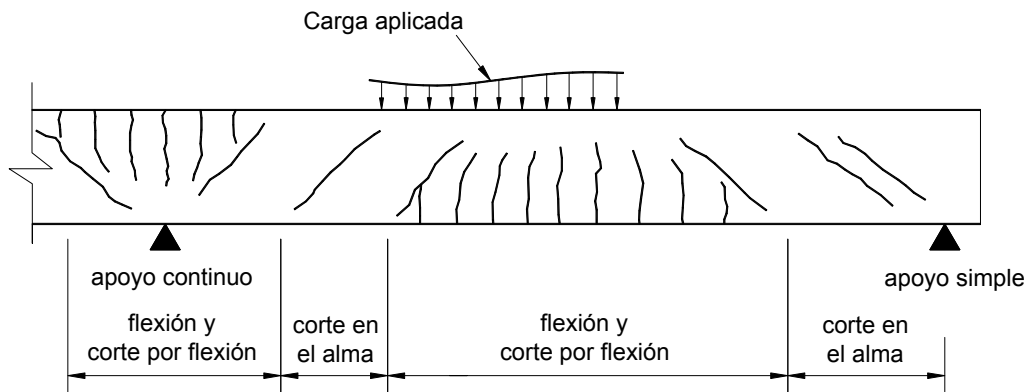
Tipos de fisuración en una viga de hormigón (Figura R11.4.2)
